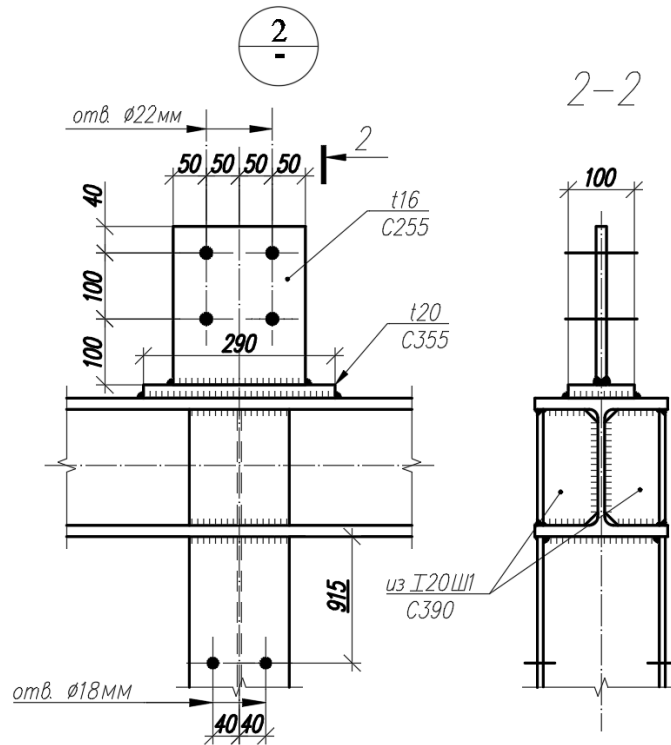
Узел 2 подстропильной фермы ФП-12-52.
